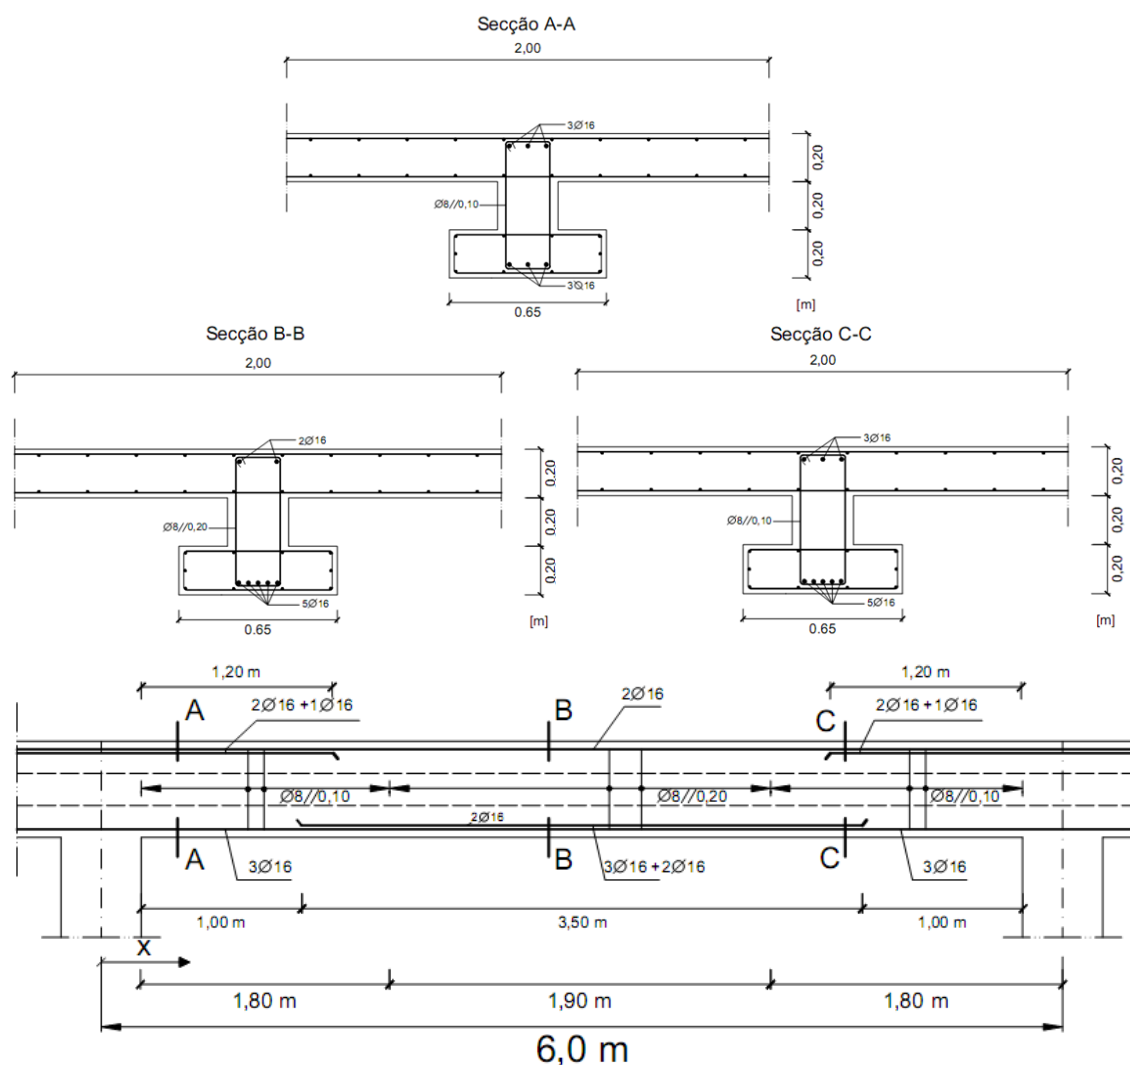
Pormenorização da armaduras (Caso D – secção em I)
